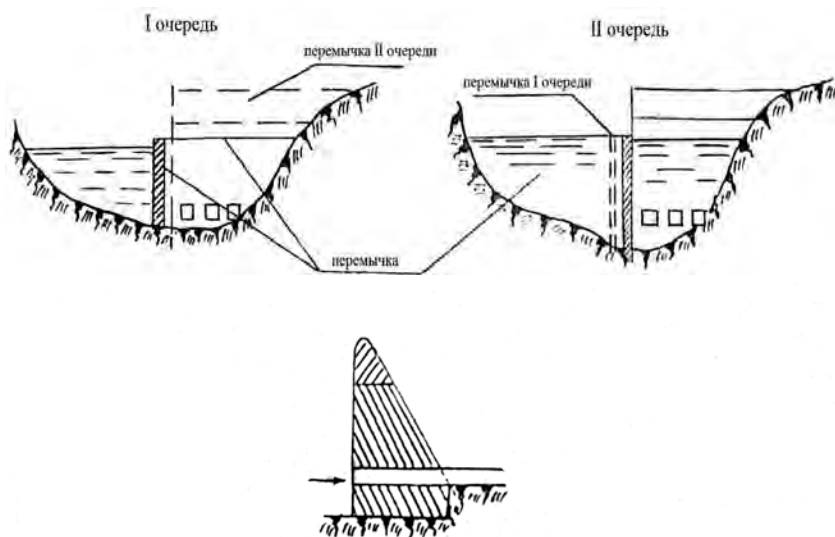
Схема пропуска строительных расходов через донные отверстия
